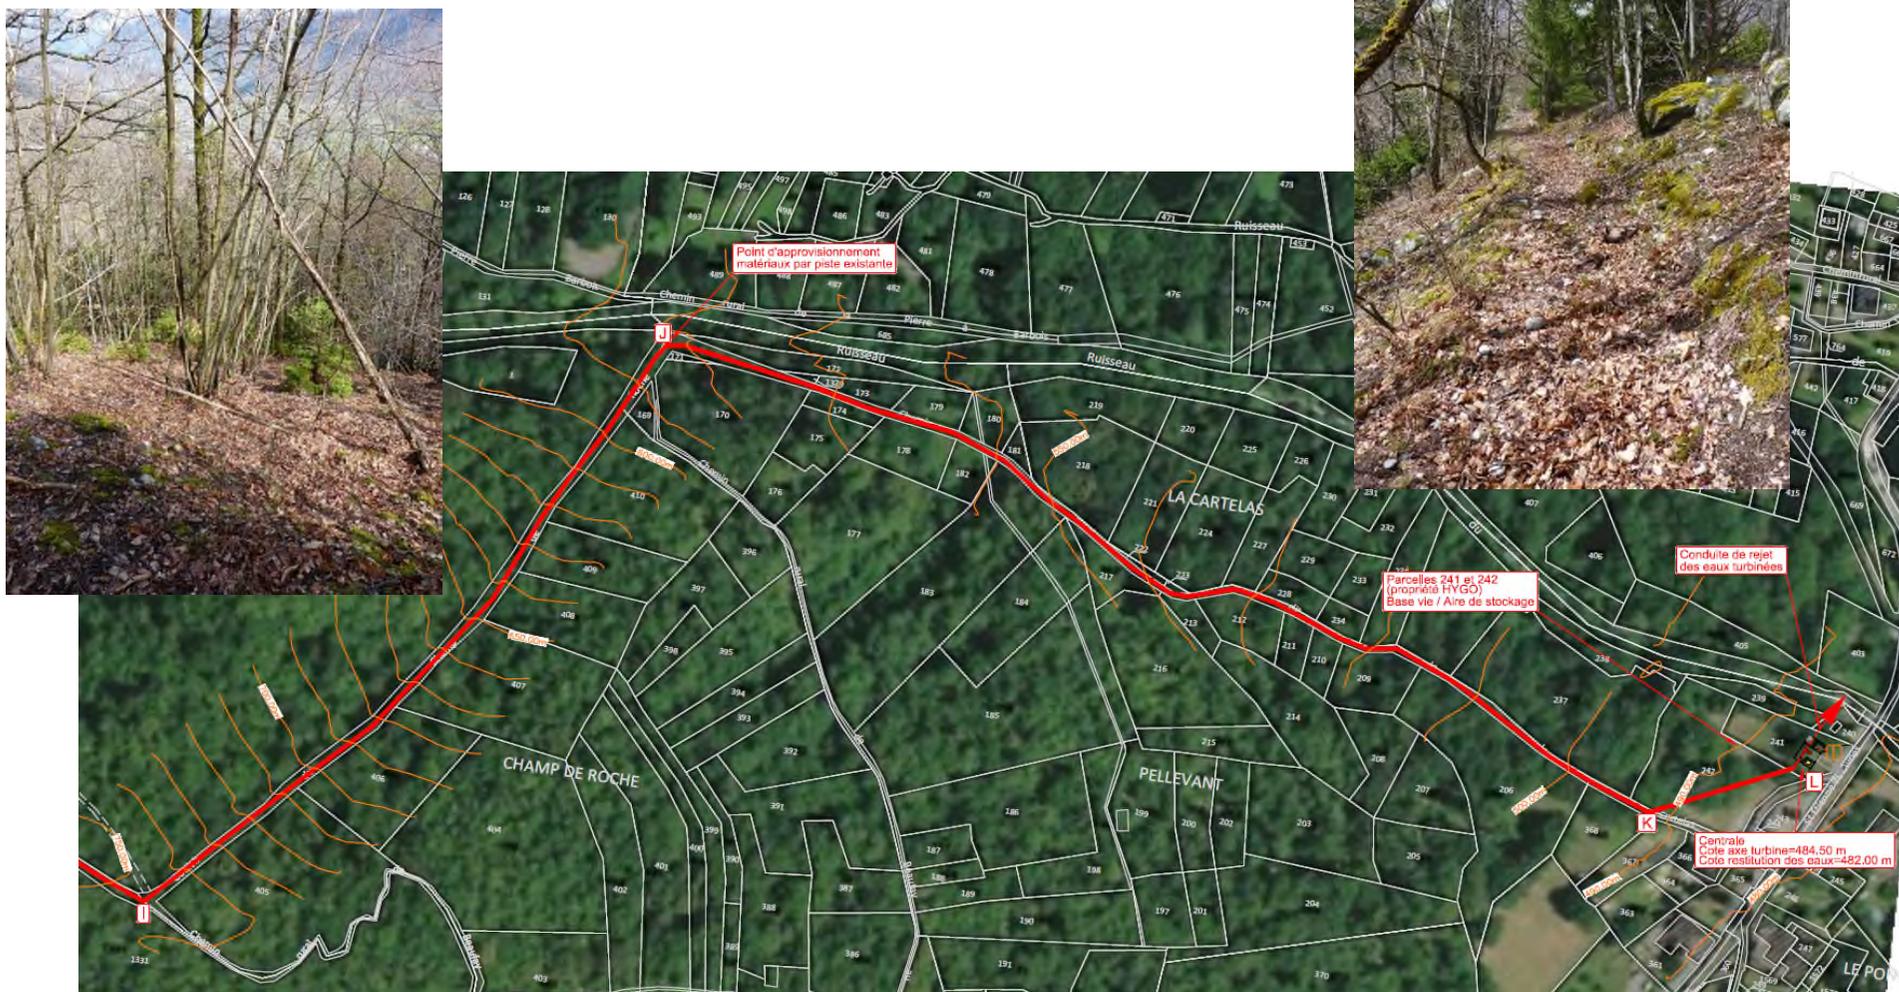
Tronçon UKL : plan et photographies (source : Profils études et Hydrostadium)
